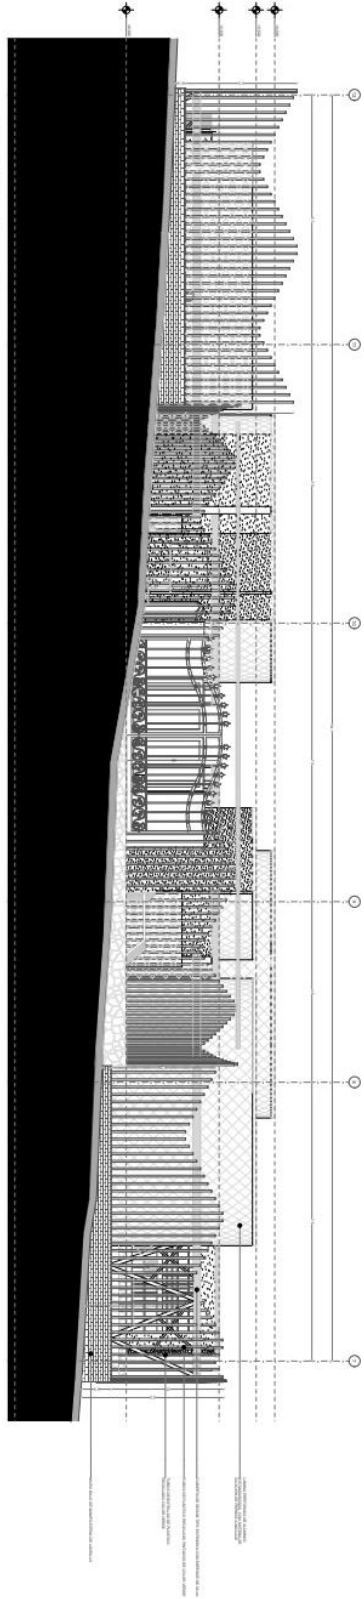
Memoria 07 planta arquitectónica cubierta del proyecto CDI
